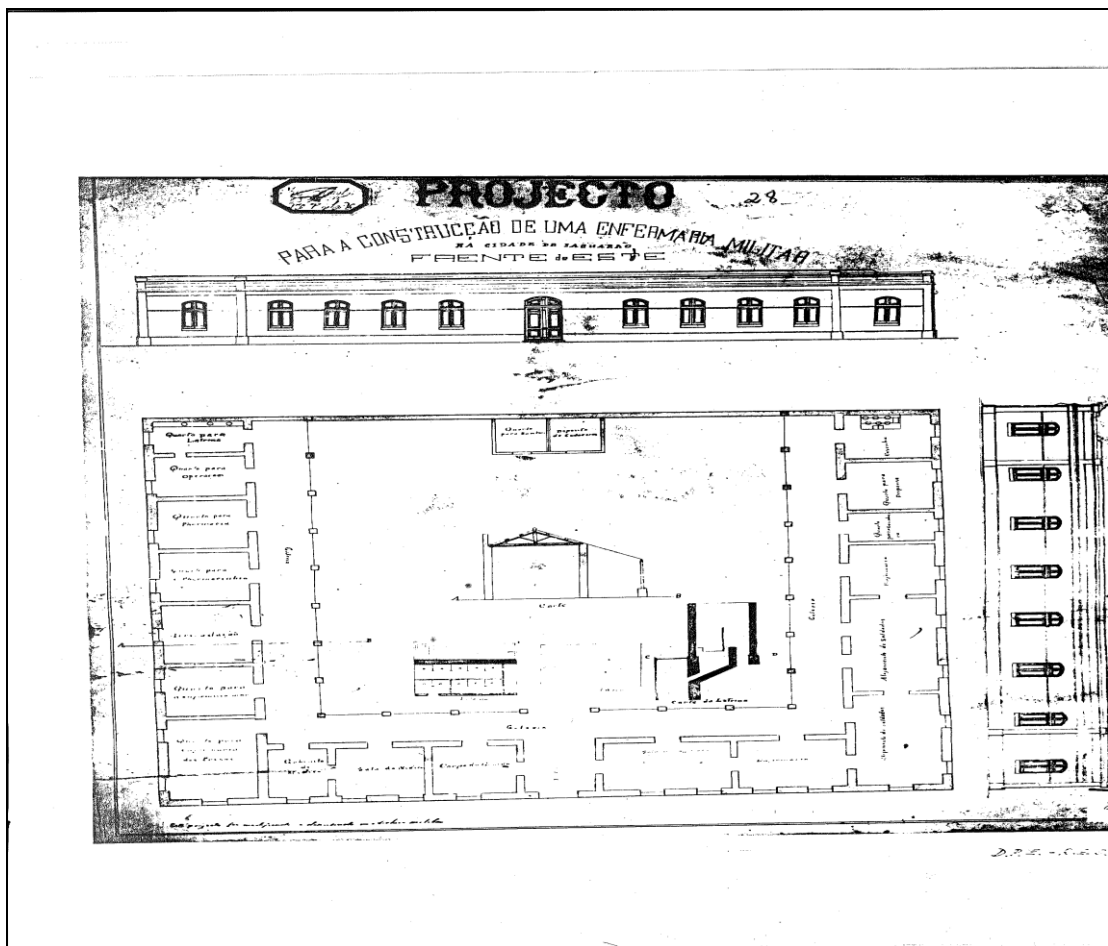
Planta baixa da antiga Enfermaria Militar, projeto inicial.
